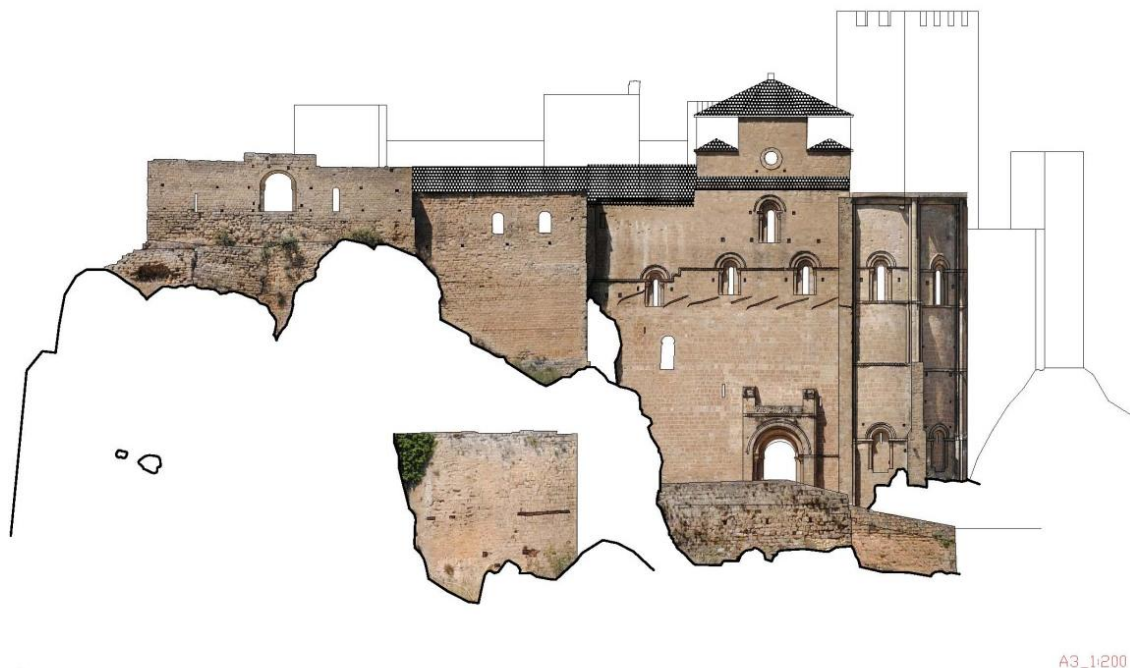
Fachada Sur del Castillo de Loarre, plano Fotogramétrico (Fuente: Dibujo del Autor).
